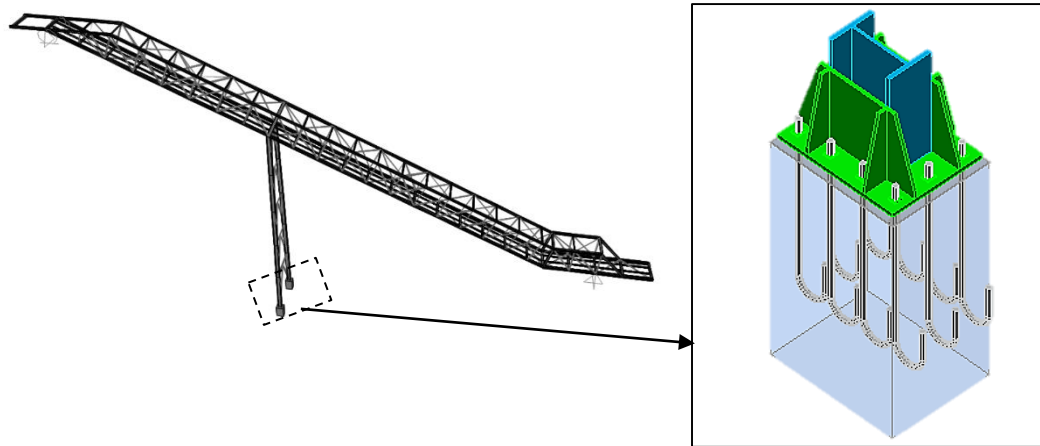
Pormenor da Ligação do Pilar ao Plinto para a combinação 1
